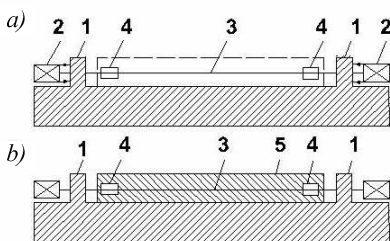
Схема натягу арматури на упори: *а* – арматура на упори закріплена, натягнута; бетон не вкладений; *б* – бетон затвердів, арматура звільнена від зв'язку з упорами – конструкція обтиснута;
